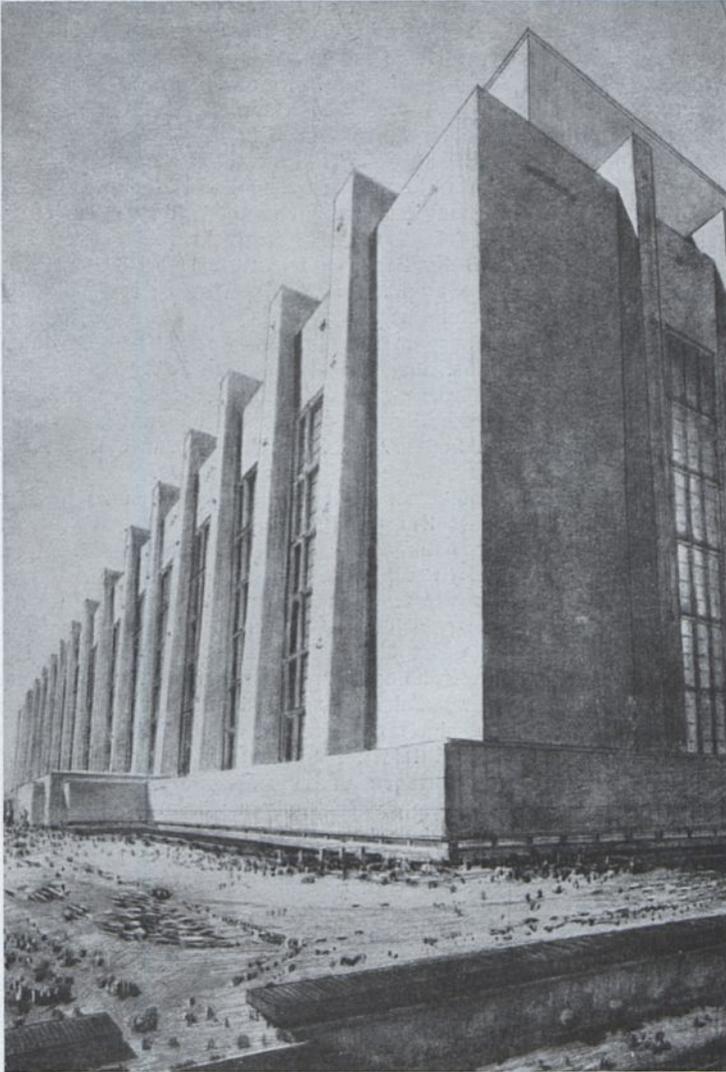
Entwurf C. u. D. Letrosne für die Pariser Ausstellungshalle.
